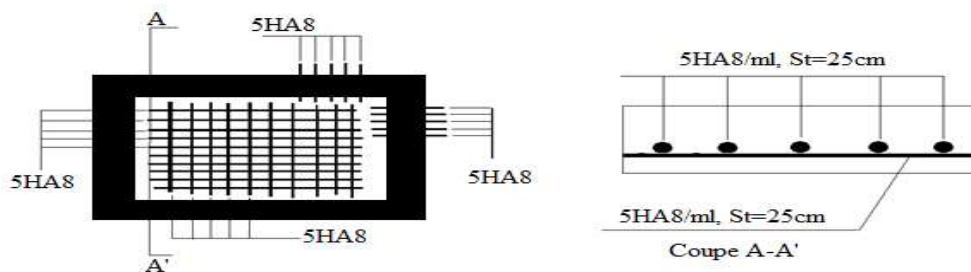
Schéma de ferrailage de dalle pleine sur quatre appuis
